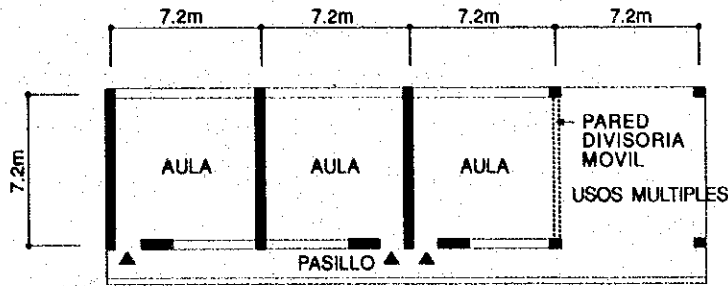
PLANTA DEL EDIFICIO DE AULAS TIPO 3-3-6 LINEAL
